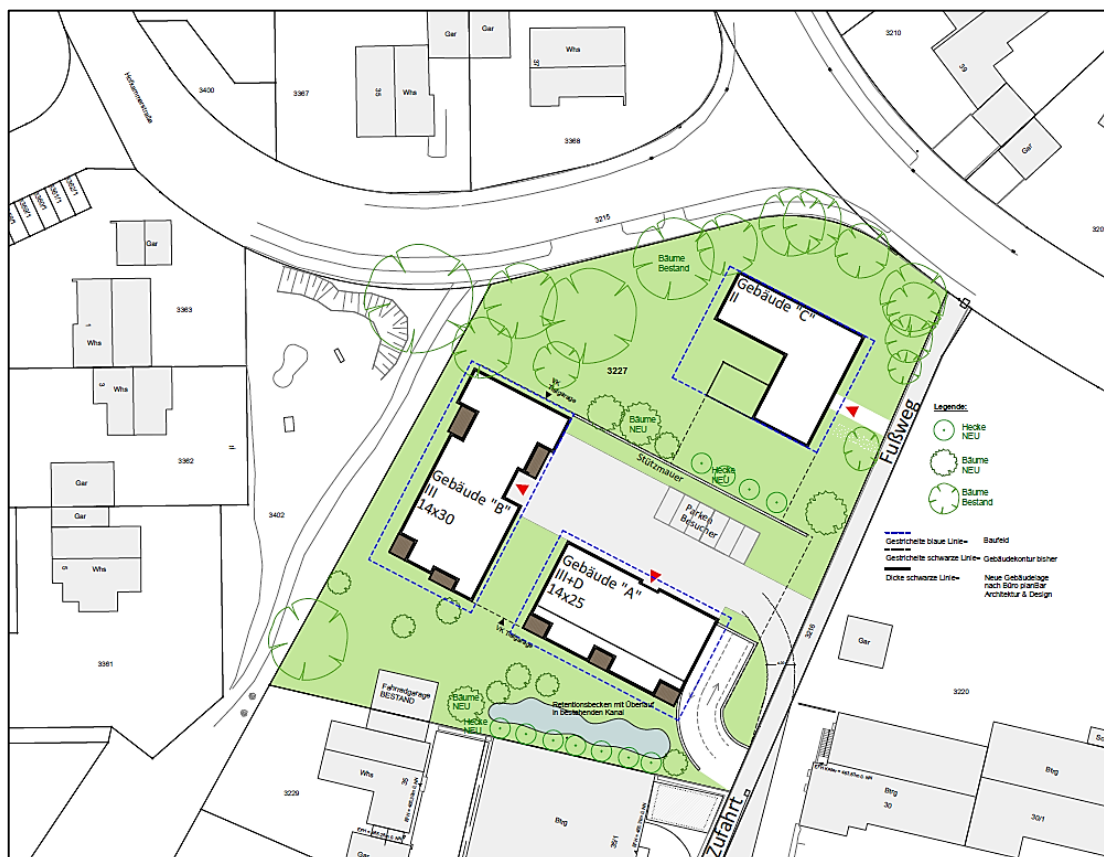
Vorhaben- und Erschließungsplan, PlanBar Architektur und Design, 2020, o.M.
